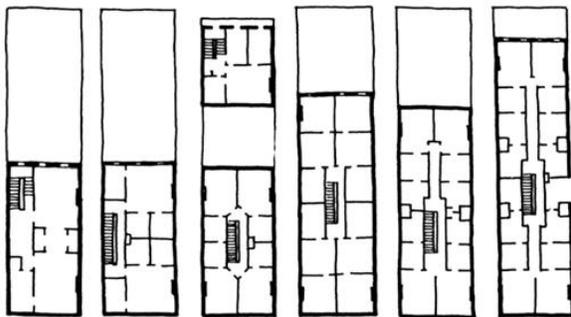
Ausencia de patios efectivos de iluminación, ventilación y secado de ropa
